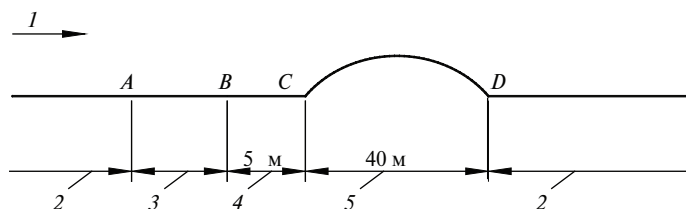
Схема изгиба рельсовой плиты при сварке с предварительным изгибом машинами ПРСМ
